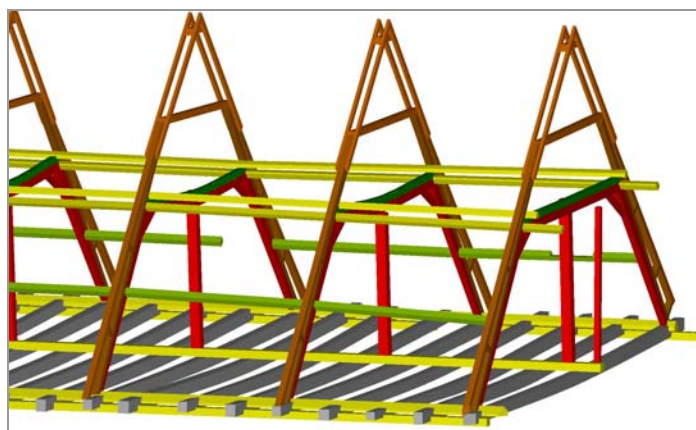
Stav krovu před poslední úpravou, převzato z [2]
